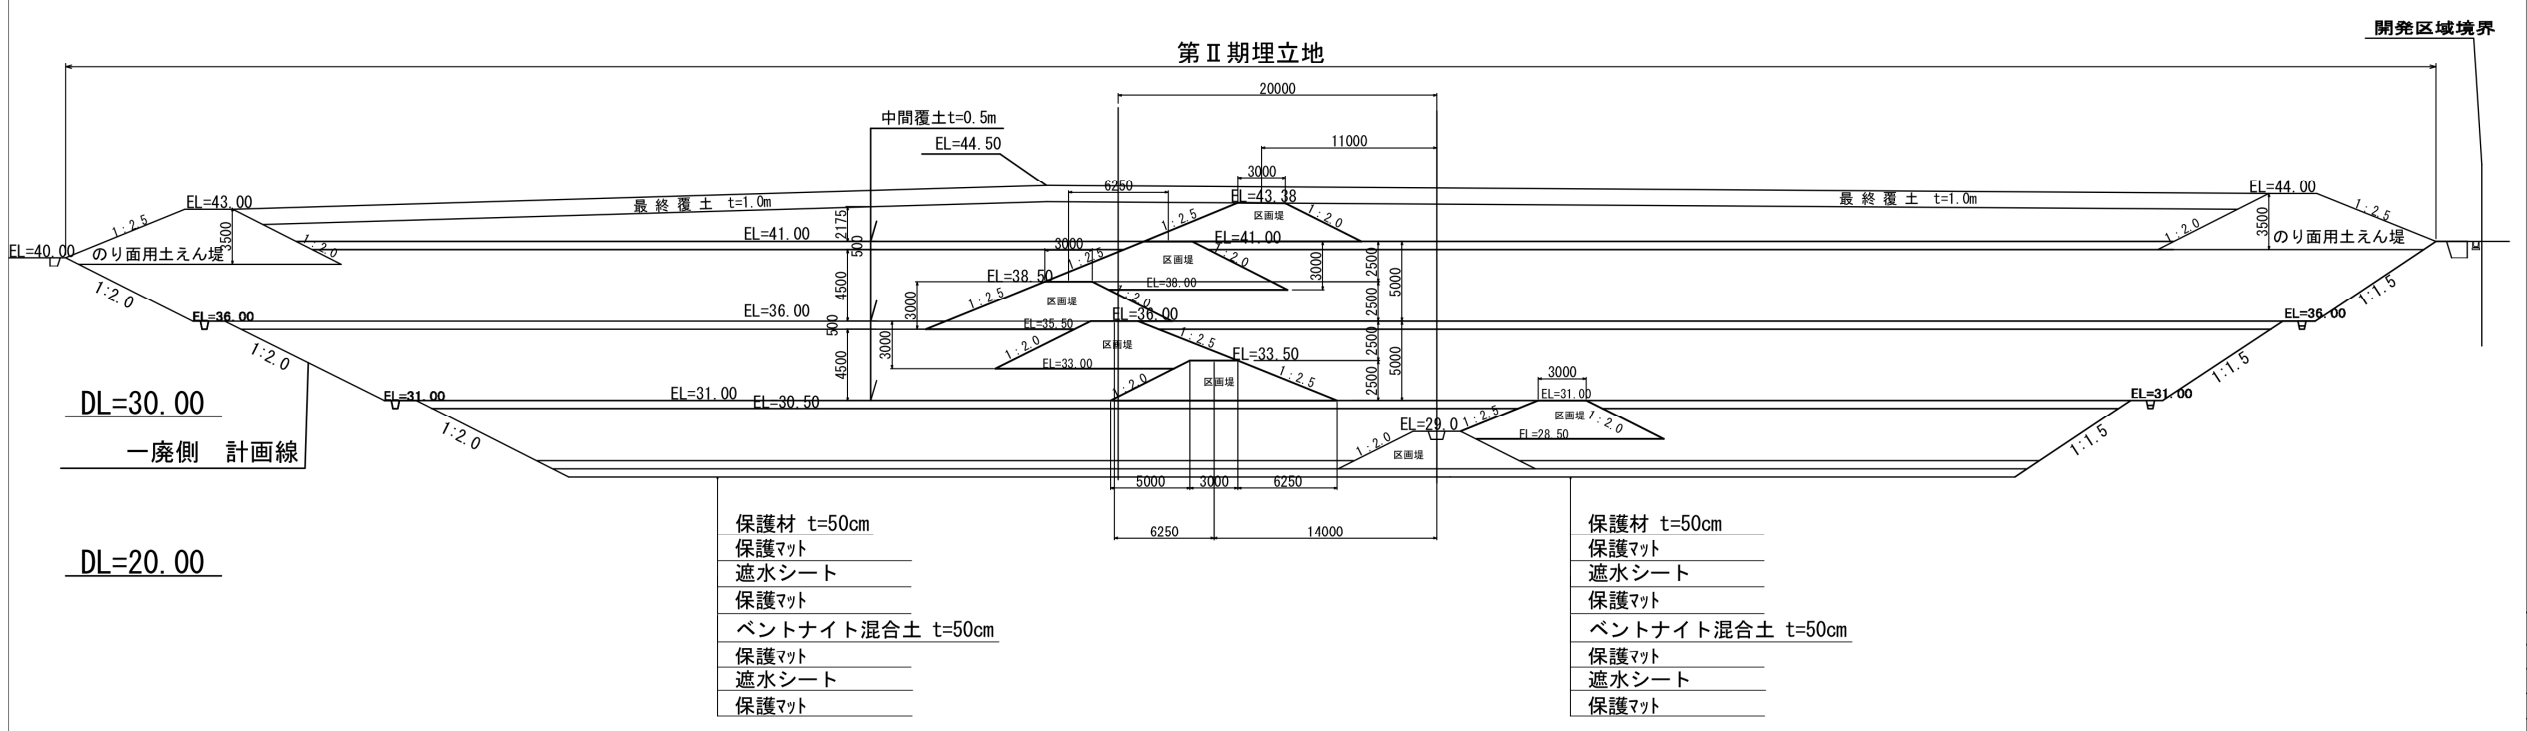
・② 事業計画地造成計画 (Ⅱ期 縦断面図・横断面図)
